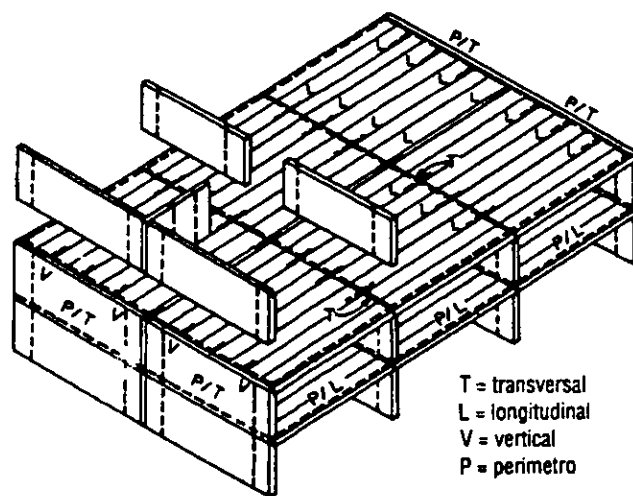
Distribución típica de conexiones en estructuras de grandes tableros
